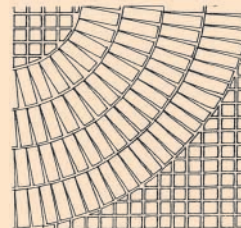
Adaptación de áreas pavimentadas a formas redondas con ayuda de pavimento de mosaico.
